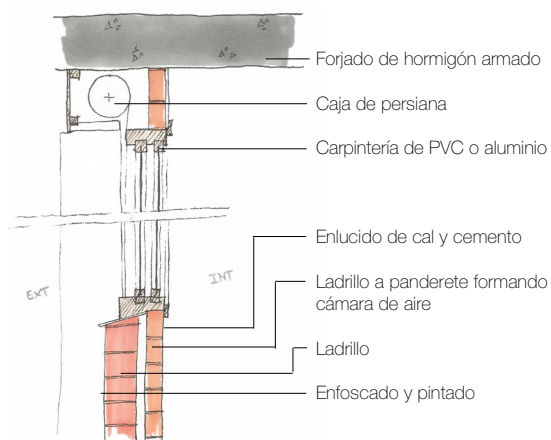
Detalle carpinterías PVC o aluminio (autoría propia).
